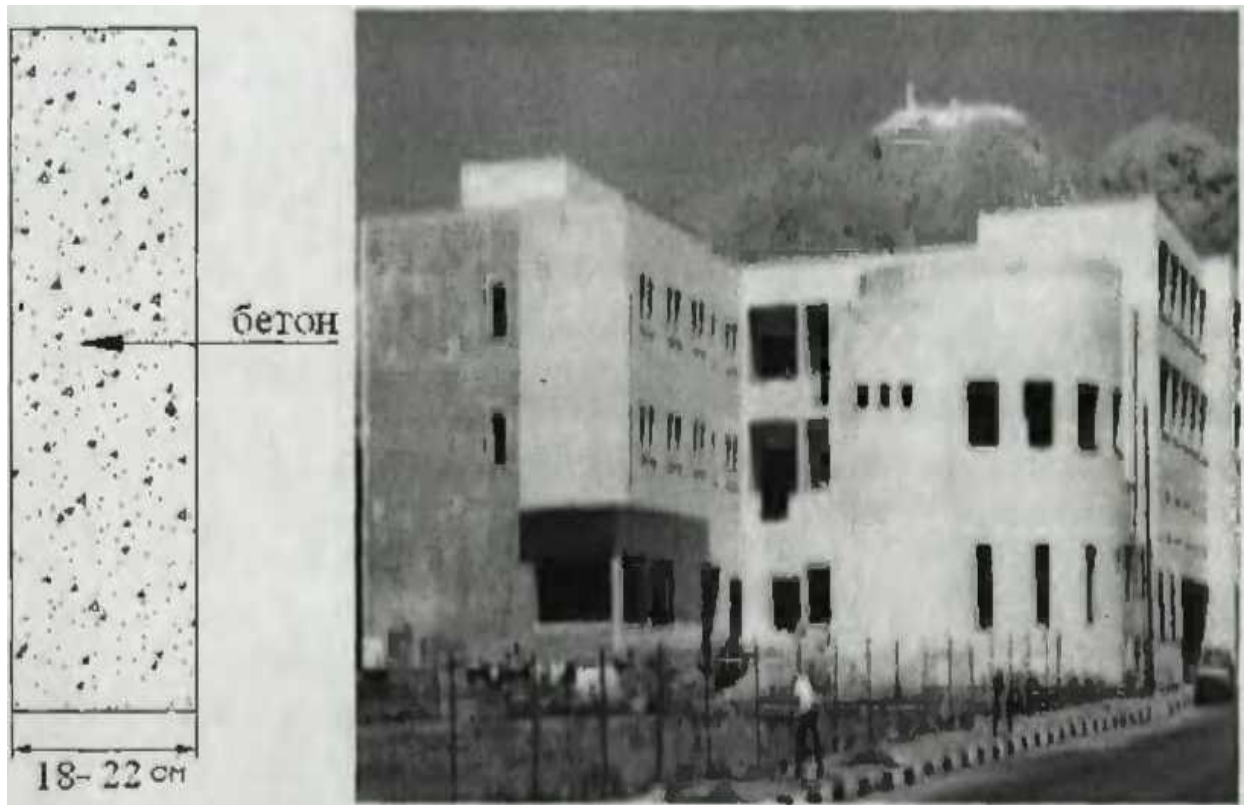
Будівля із залізобетонними стінами завтовшки (18-22 см)
